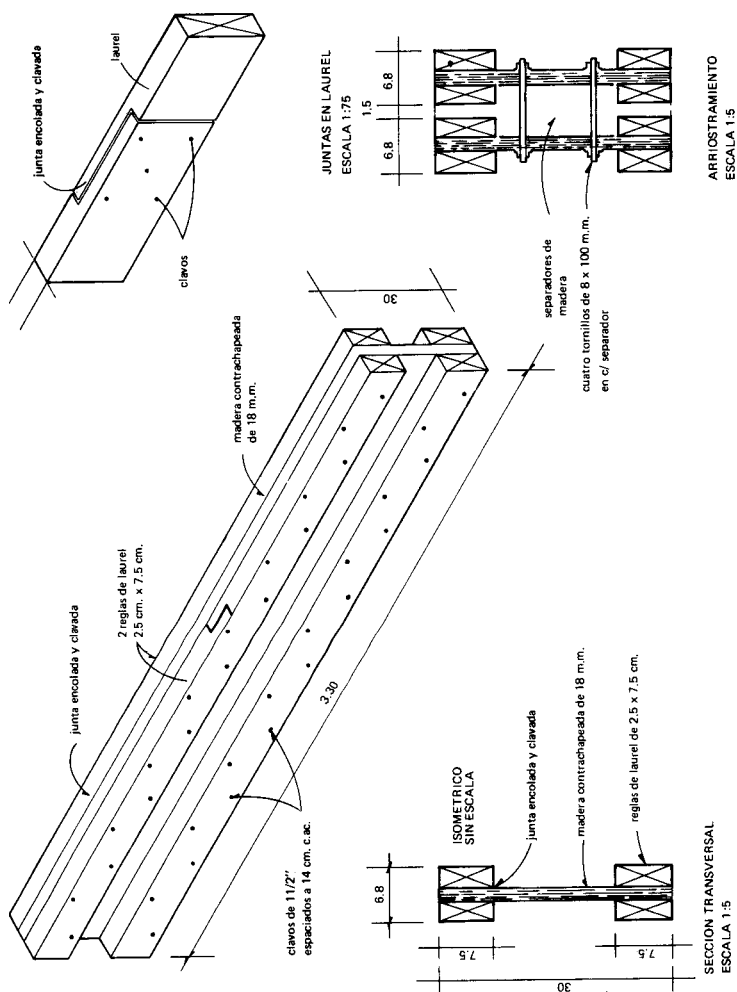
Características de las vigas H y arriostre para el ensayo de flexión empleadas por Fernández.
